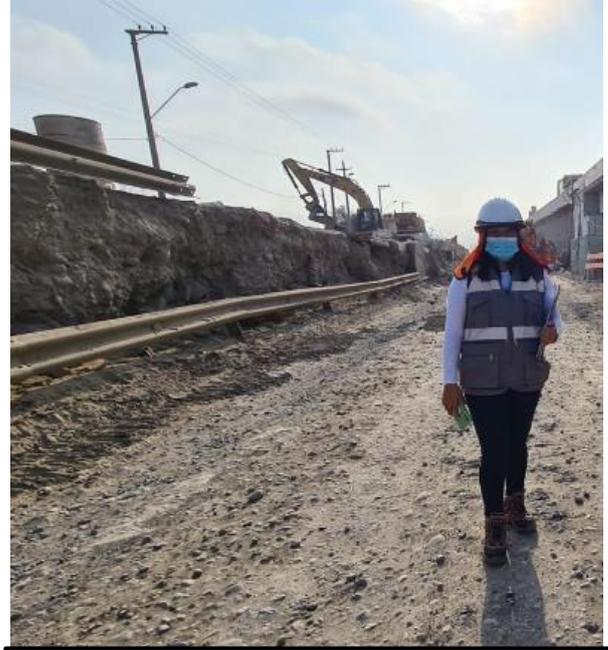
Se observa inicio de la primera encuesta realizado en obra en la construcción del Puente Ramiro Prialé.
